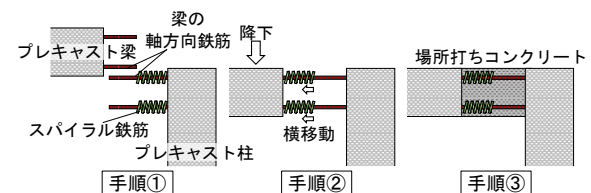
スパイラル鉄筋で補強した重ね継手構造と施工手順の案
